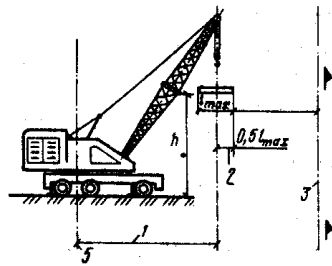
Зоны влияния крана: 1- зона работы крана, 2-зона перемещения груза, 3-опасная зона работы крана, 4-опасная зона поворотной платформы
